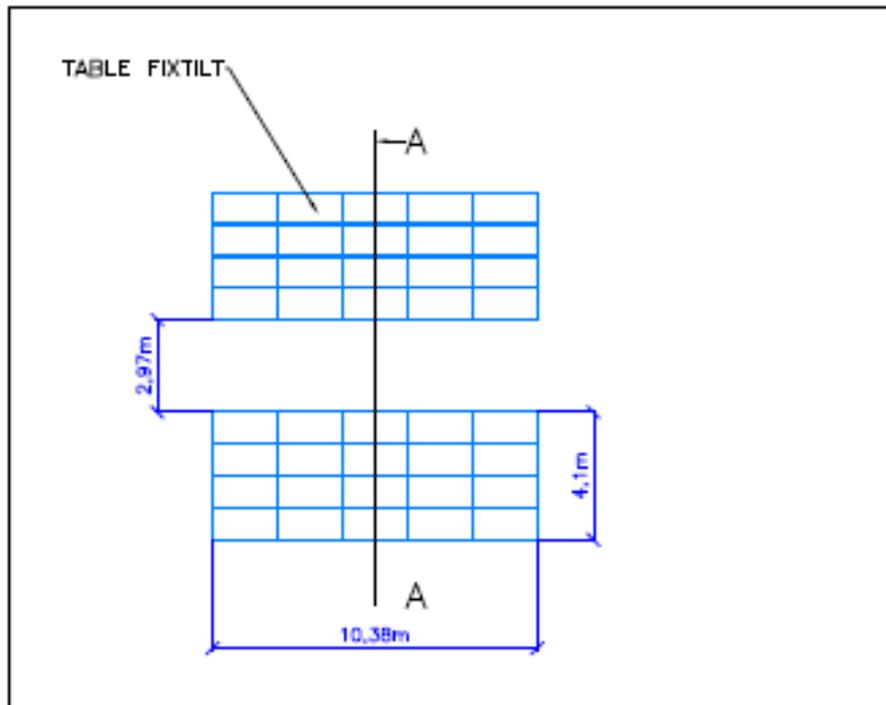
Plans des structures et panneaux (source : Total Solar)
